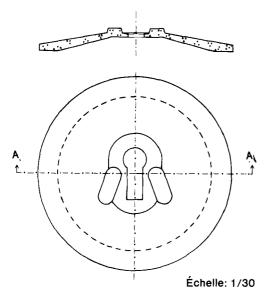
Plan et coupe transversale de la dalle en béton ordinaire utilisée pour les cabinets à fosses traditionnels. Le béton comprend: du ciment: du sable de rivière: des graviers de 1/4 de pouce dans une proportion de 1:2:1,5. Lors du contrôle, la dalle résistait au poids de 9 personnes mais non de 10. Chaque dalle est soumise à un contrôle et doit obligatoirement soutenir le poids de six personnes avant d'être posée sur une fosse et mise en service.
